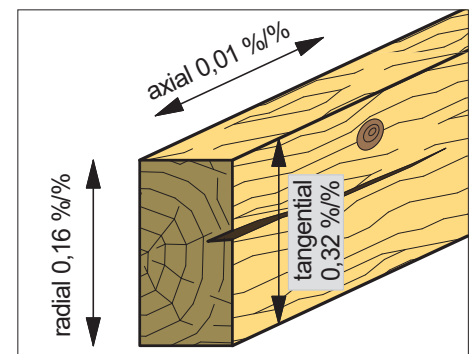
Schwind- und Quellmaße für die Holzart Fichte.
